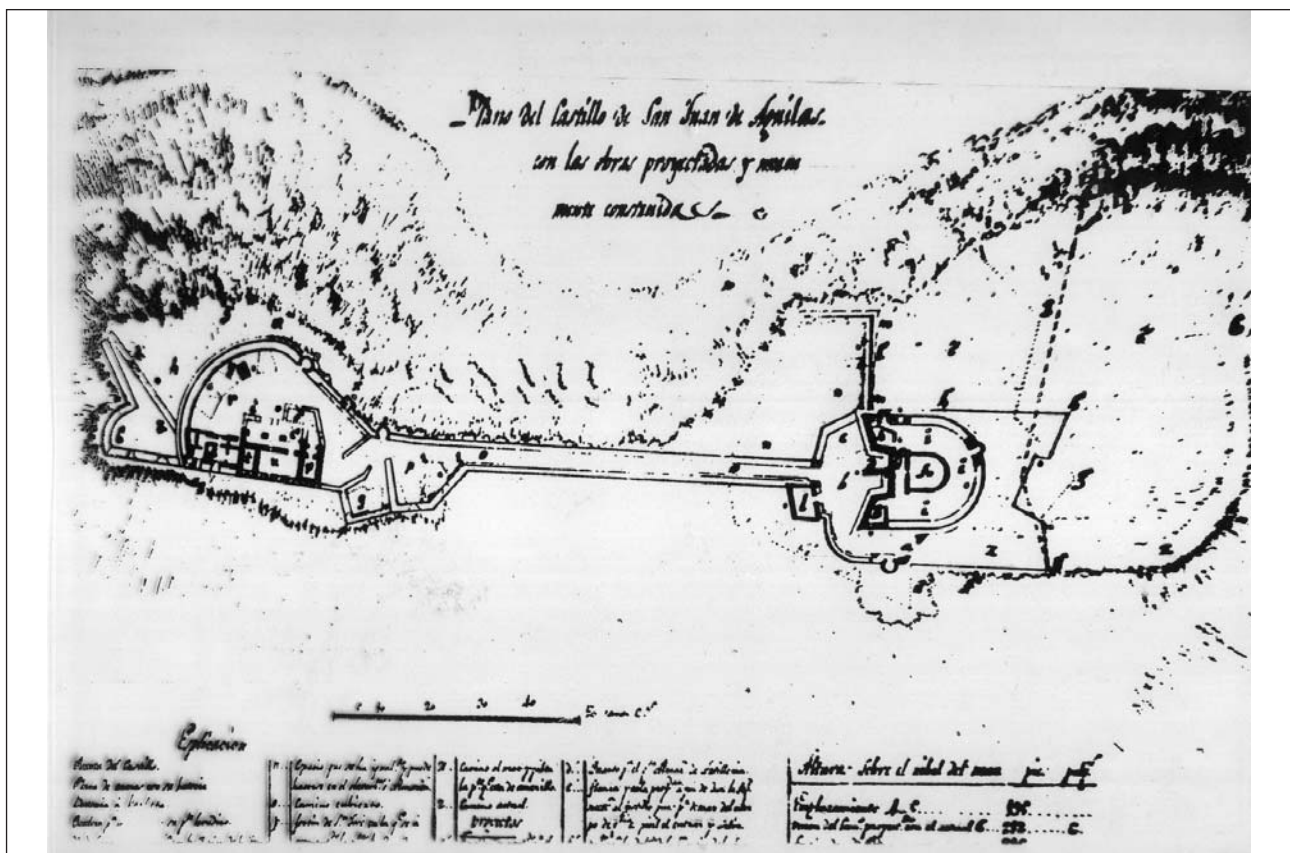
Plano del Castillo de San Juan con obras proyectadas y nuevamente construidas (1785).
